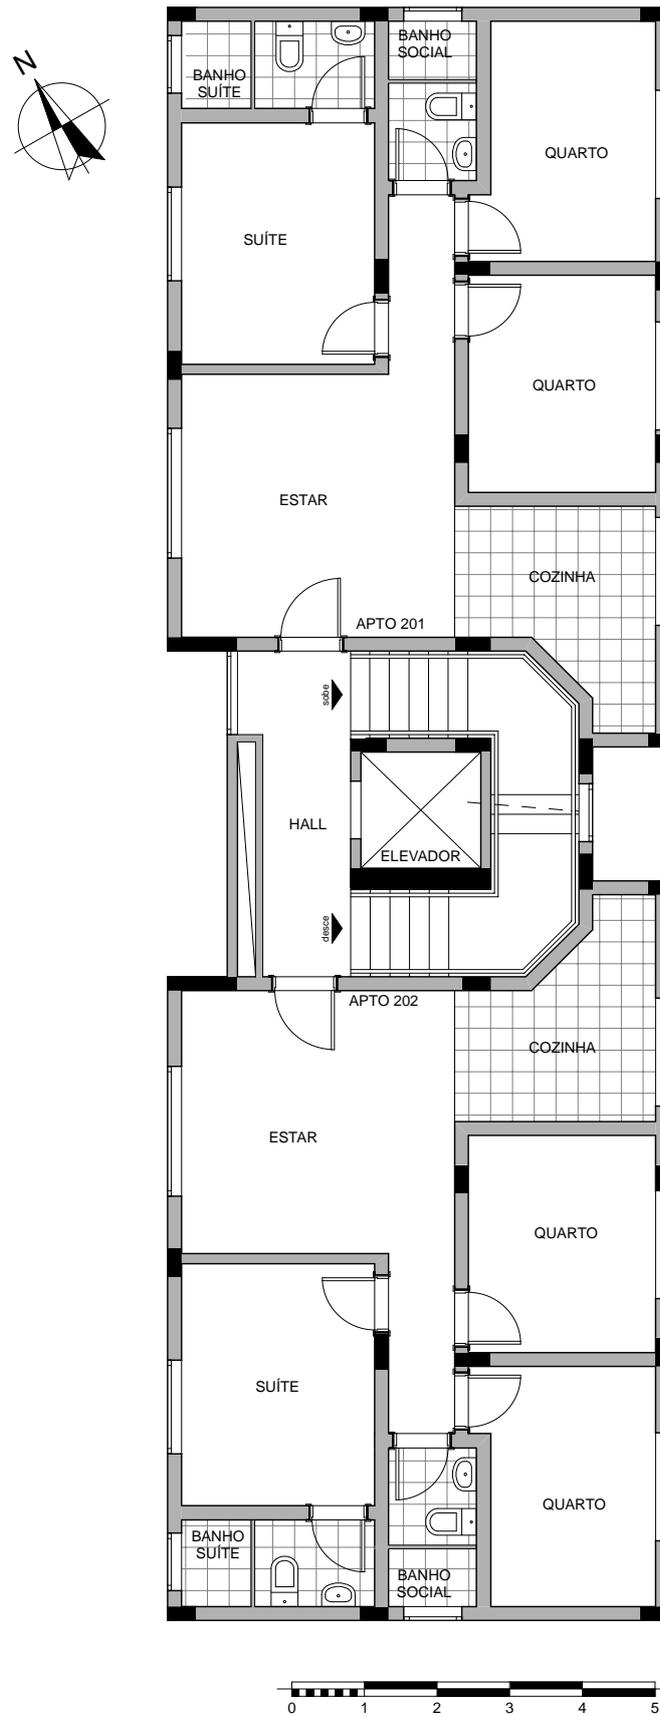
Planta 2º pavimento (Fonte: Autora, 2016)
